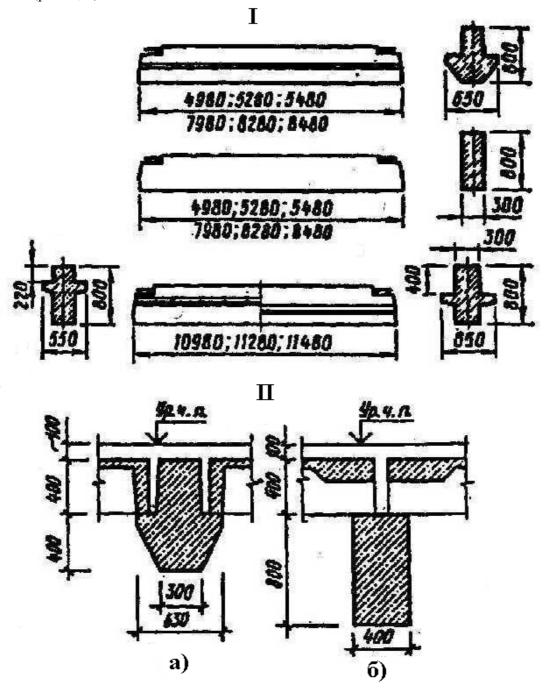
Ригели: I – ригели перекрытий пролётами 6, 9 и 12 м; II – ригели (a – для перекрытий типа I; δ – для перекрытий типа II)
